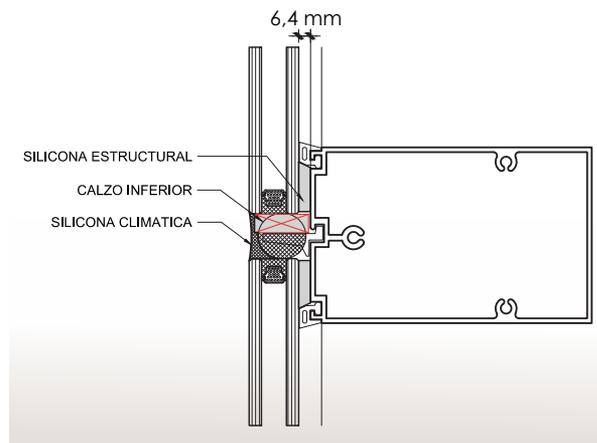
Detalle típico de muro cortina con silicona estructural cuatro lados, con DVH y calzo inferior.
